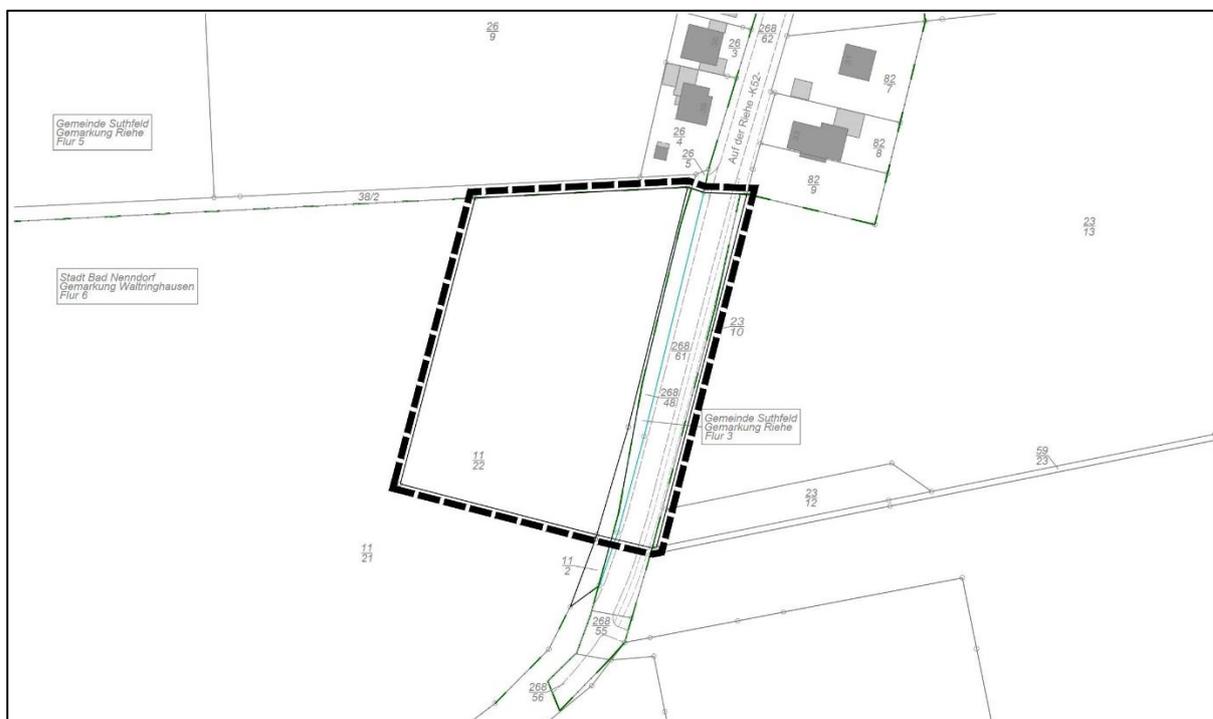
Lageplan mit Geltungsbereich – unmaßstäbliche Darstellung
